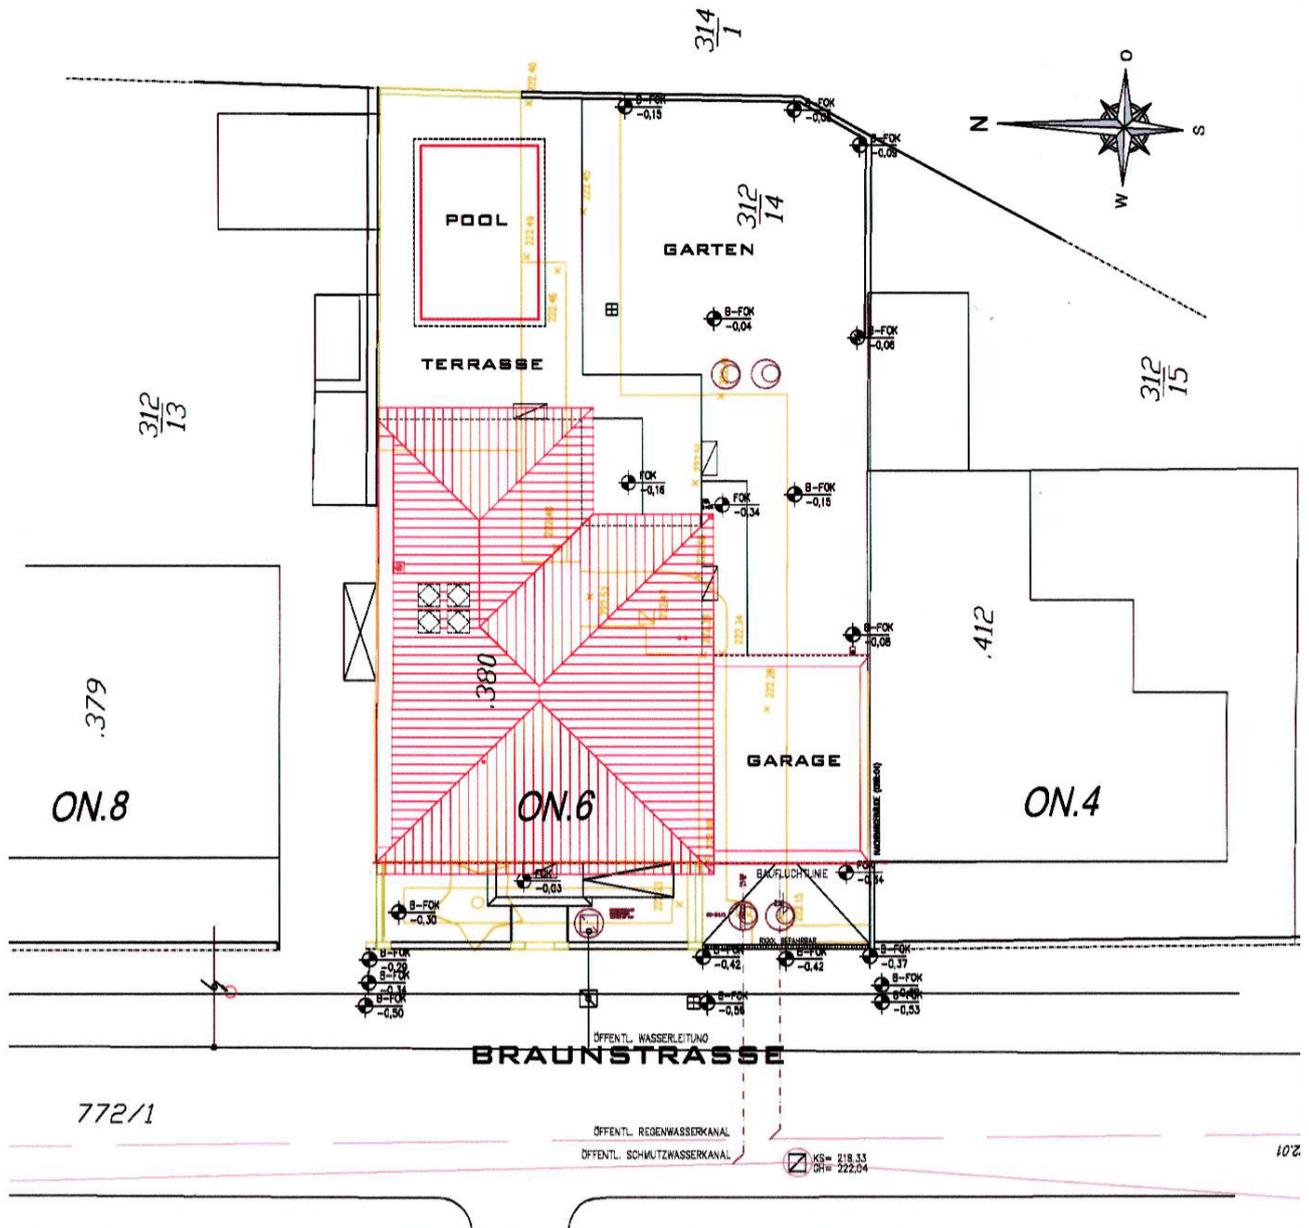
Lageplan | Einreichplan | Pongratz Bau GmbH (gezeichnet von Dipl.-Ing. Gassenbauer) | 01.04.2010
